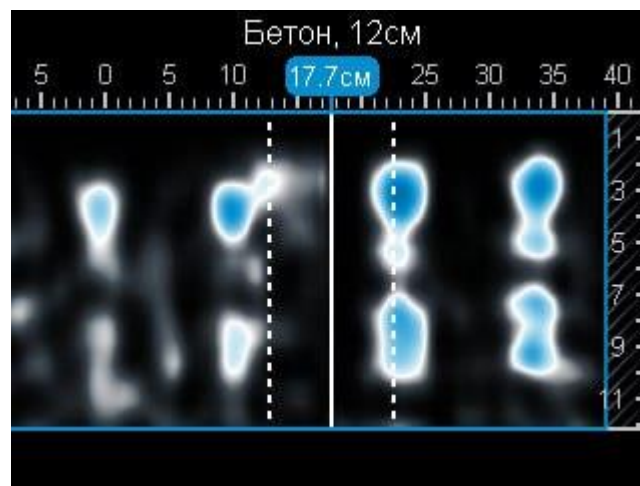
Расположение армирования по наружной стороне дна чаши (радиальное заглубление армирования). Защитный слой 10...15мм. Шаг 110...140мм
